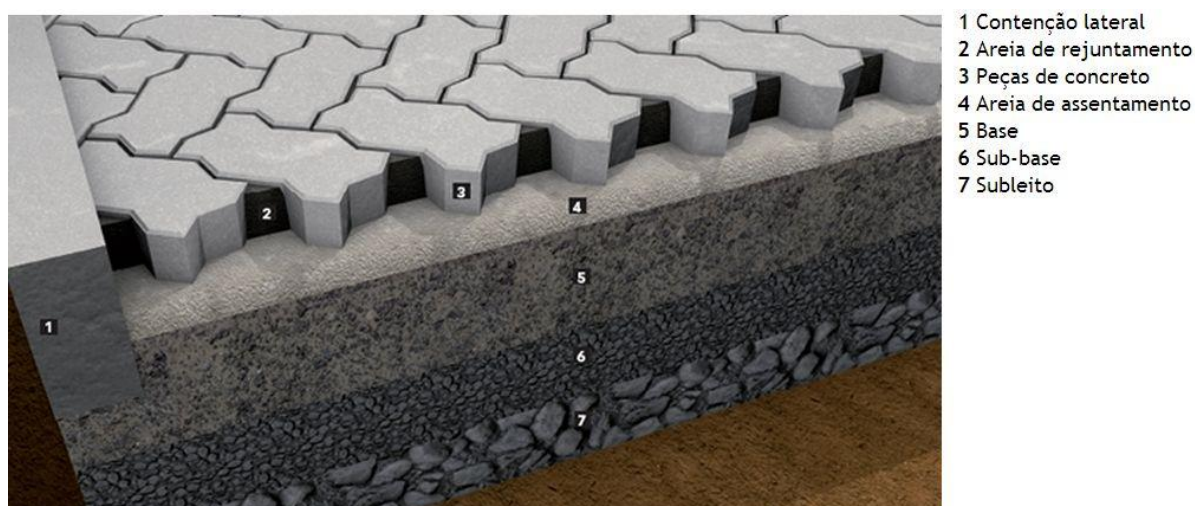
ESQUEMA DE PAVIMENTO INTERTRAVADO
